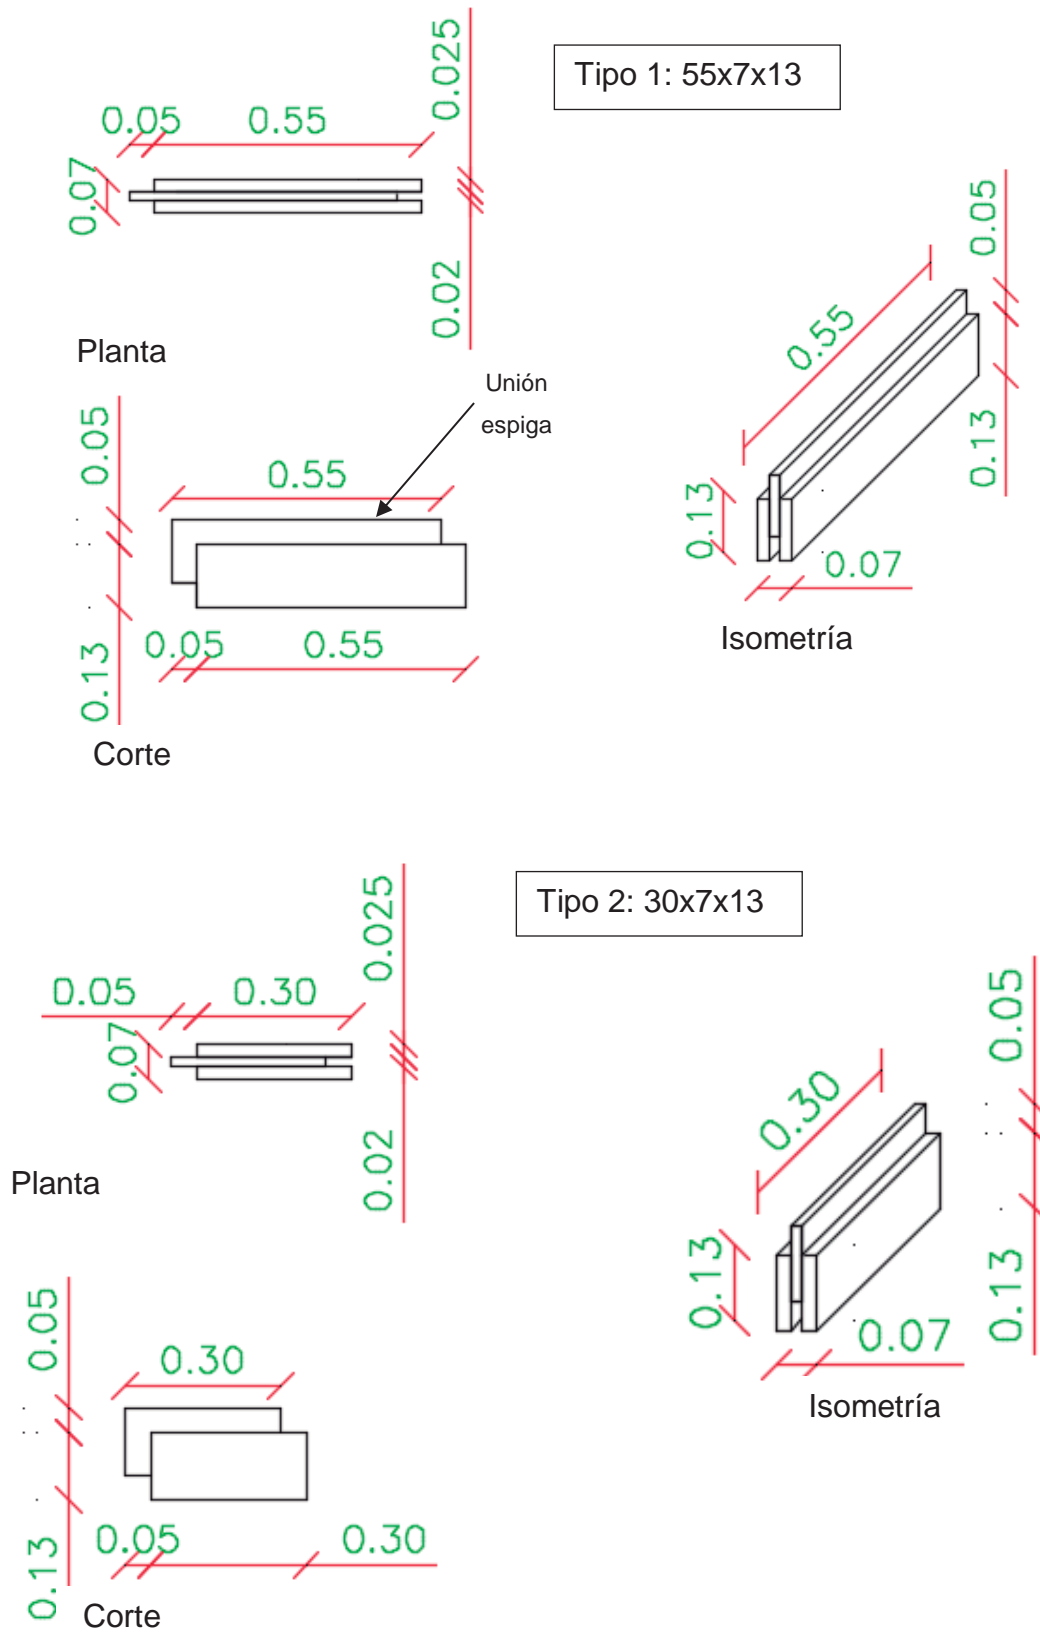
Bloque plástico reciclado sin perforación para traslapado de mamposterías - AutoCAD, 2018
